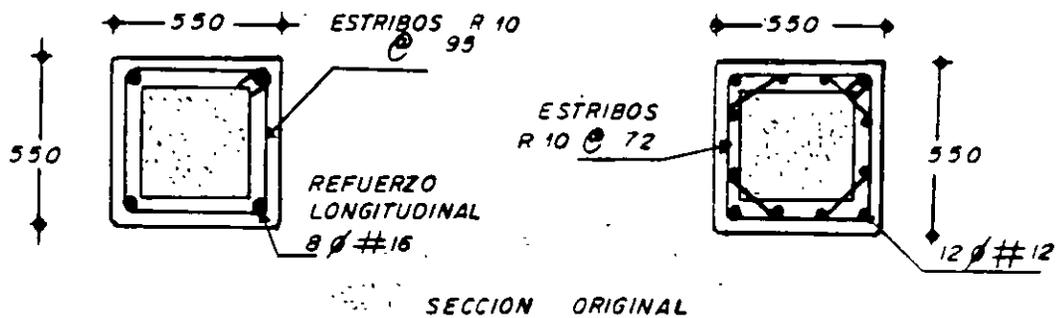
Dimensiones y detalles de las columnas reforzadas con camisas de concreto reforzado que se probaron en la Universidad de Canterbury.
